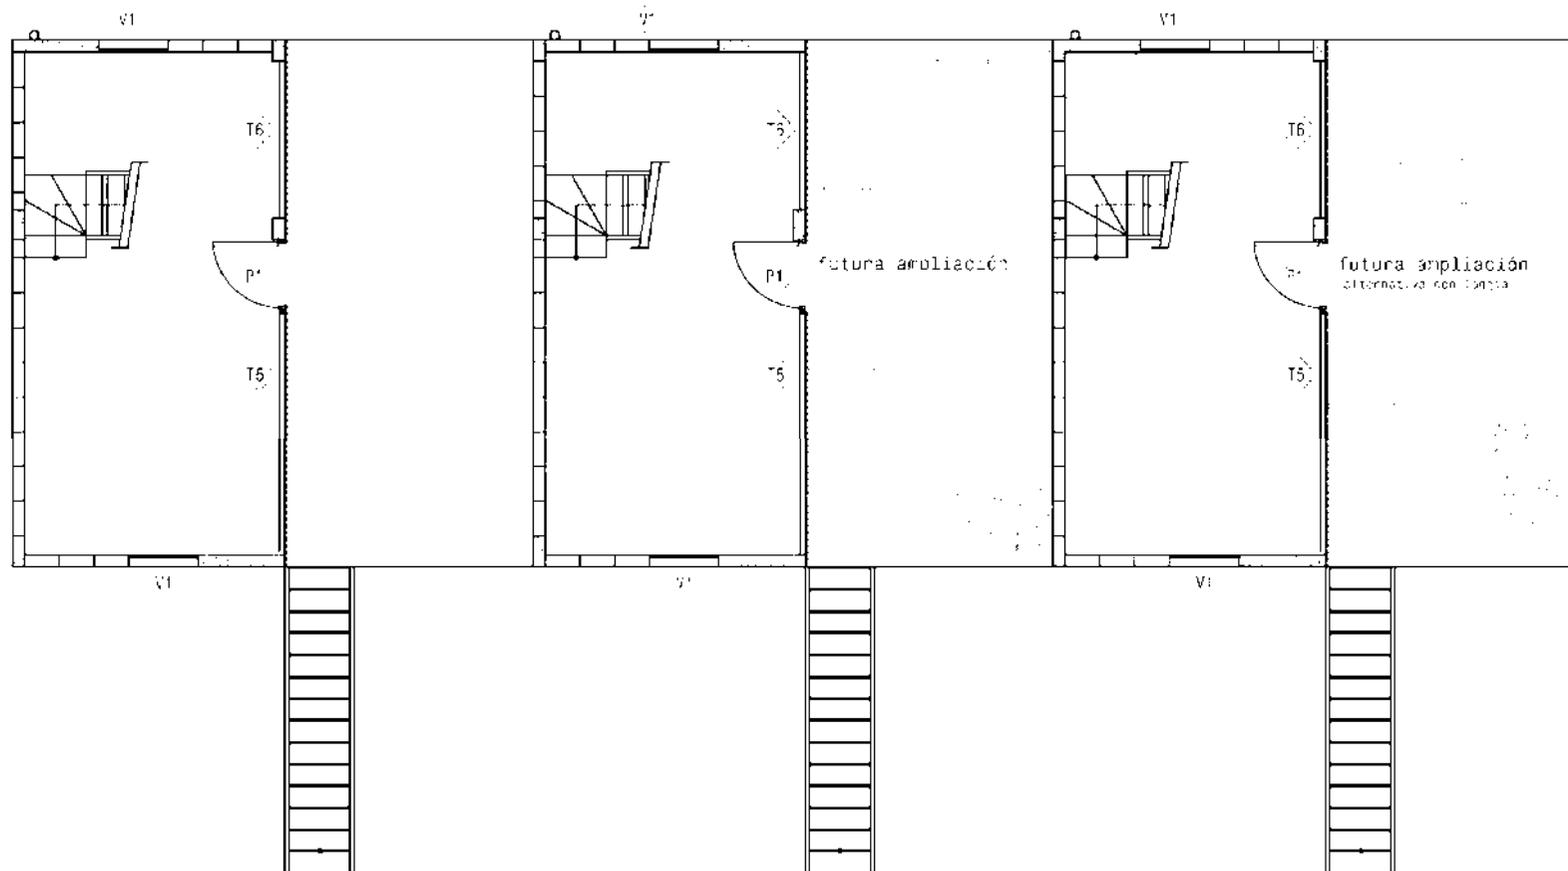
Planta arquitectónica de la plata baja, Quinta Monroy, Iquique, Chile, Alejandro Aravena
